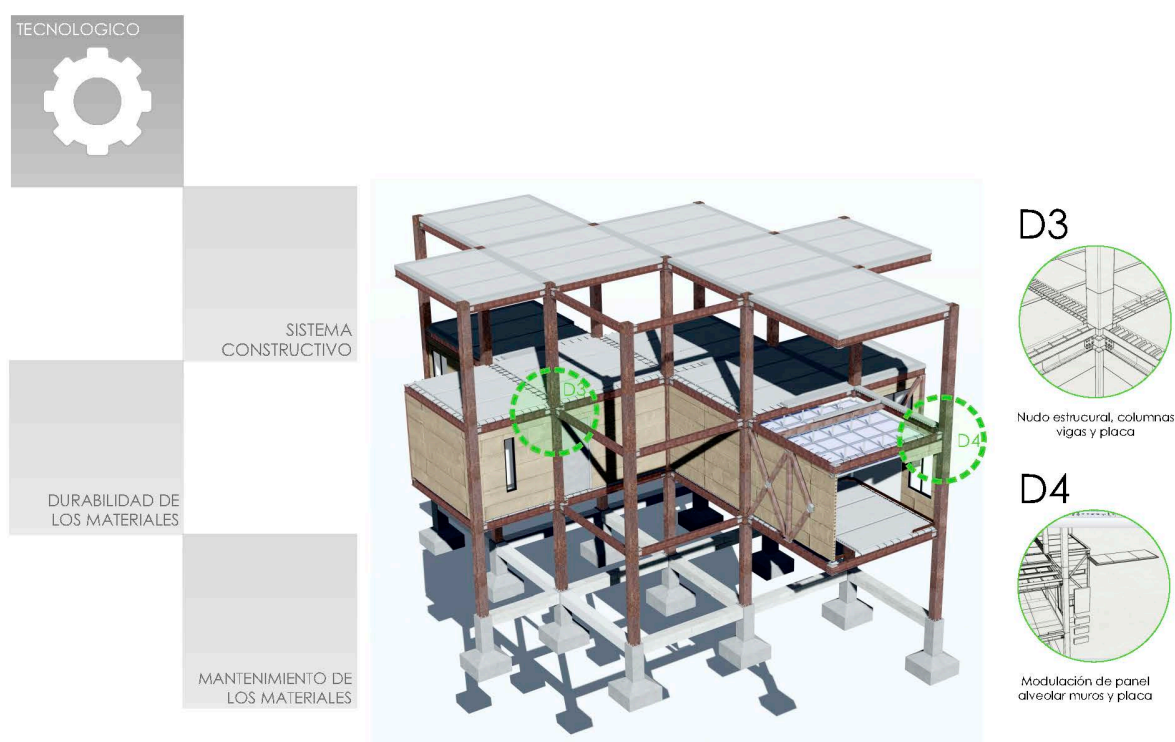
Componentes estructurales del proyecto, estructura metálica (Elaboración del autor)
